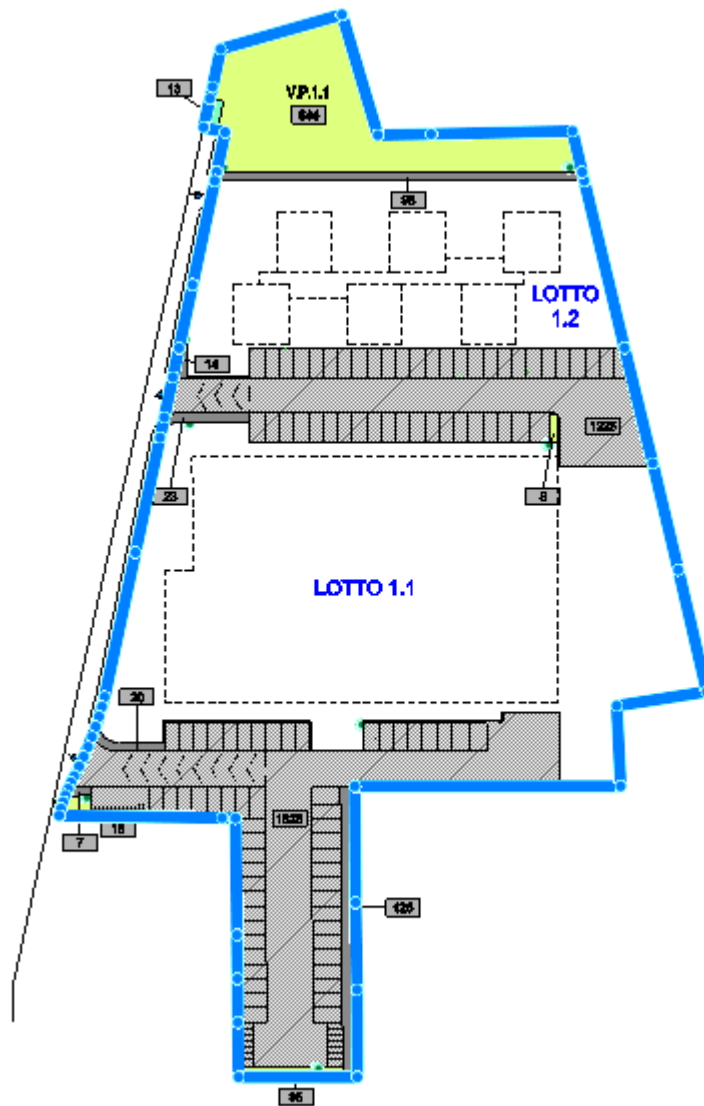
Planimetria dell'intervento con indicazione dei Lotti
